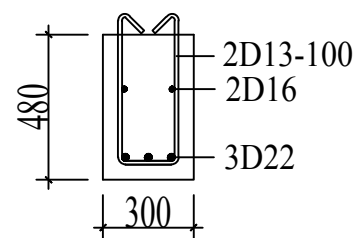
DETAIL BALOK INDUK TIPE B2B SETELAH KOMPOSIT
